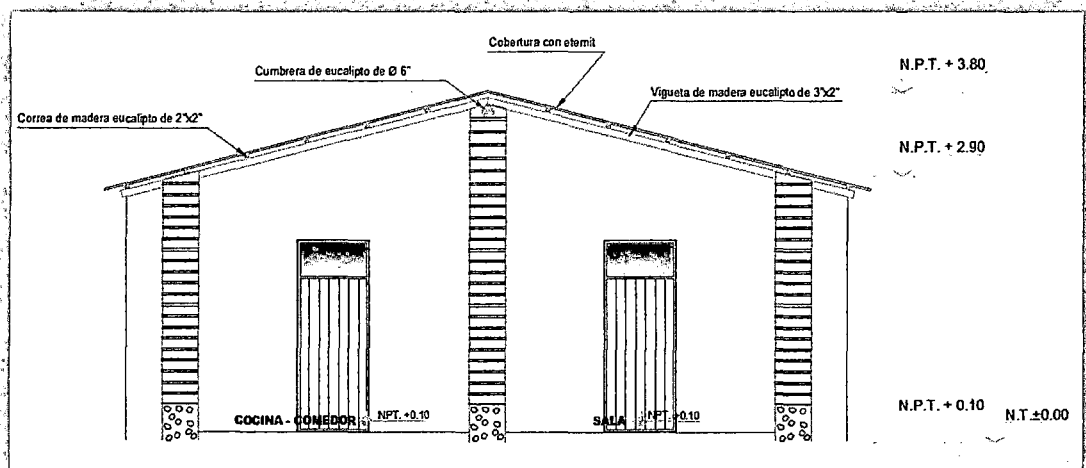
Vista de corte lateral de vivienda propuesta.
